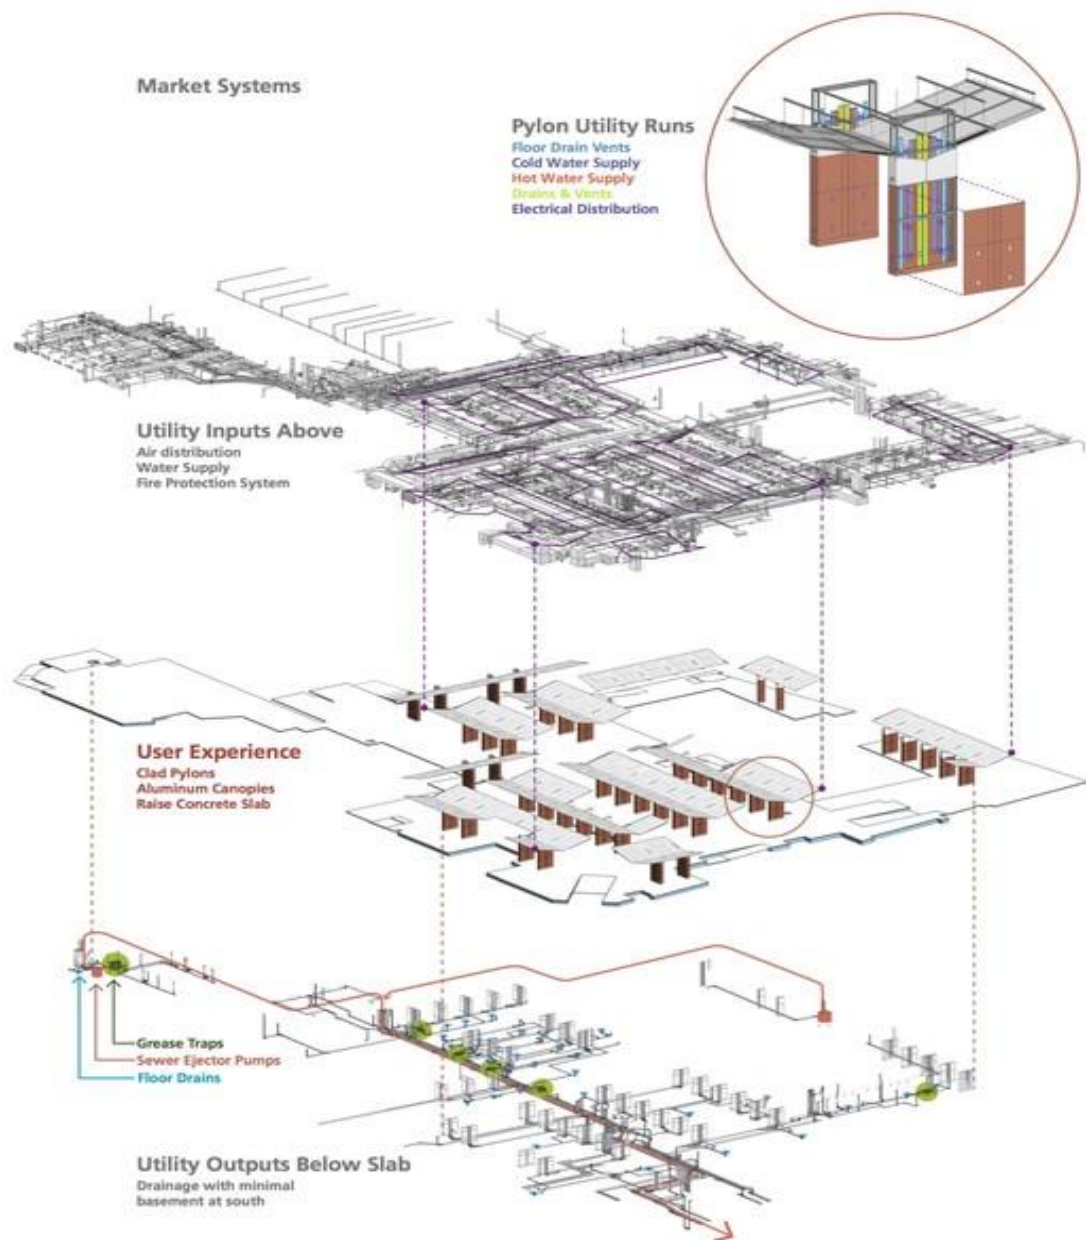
Isometría del Mercado Municipal. Fuente: de Archdaily (2018).
